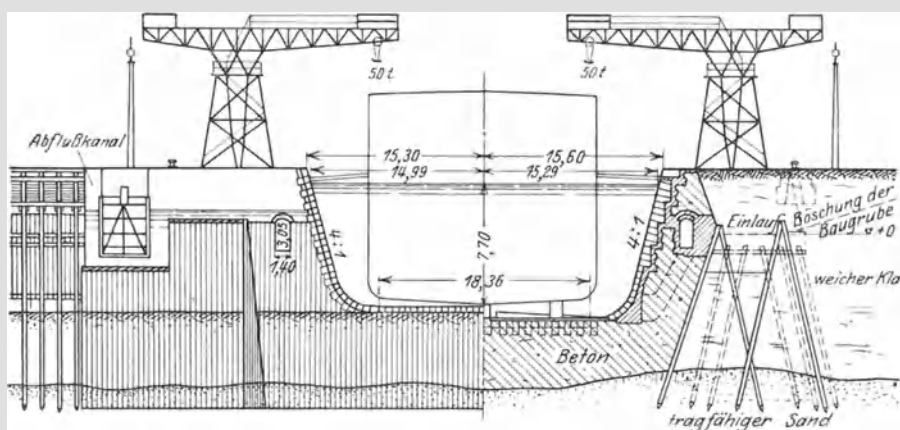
Kaiserdock Bremerhaven, links Ansicht auf Binnenhaupt, rechts Schnitt der Kammer.
